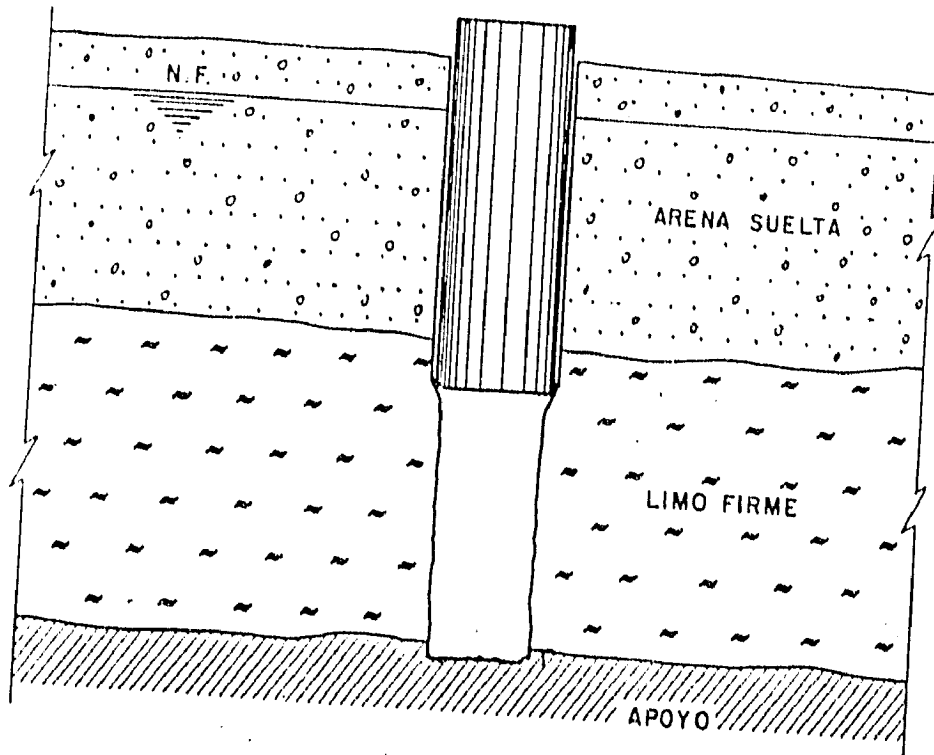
HINCADO DE ADEME METÁLICO EN SUELOS ESTABLES.
